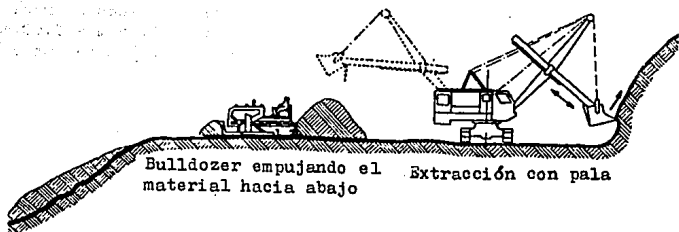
Trabajo realizado conjuntamente por dos máquinas.
